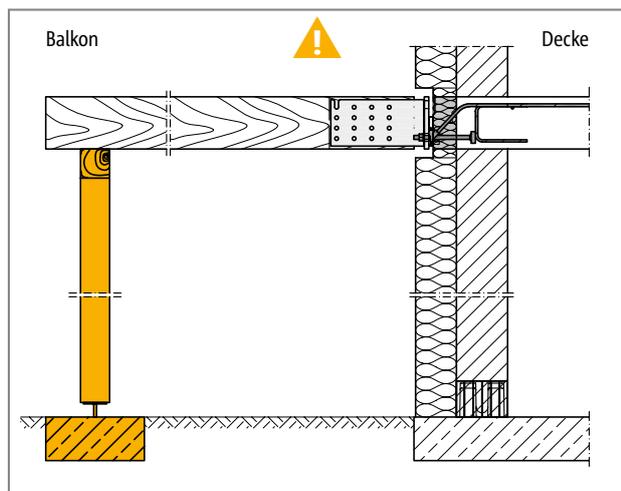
Schöck Isokorb® T Typ SQ mit Stahlschwert: Stützung durchgängig erforderlich
